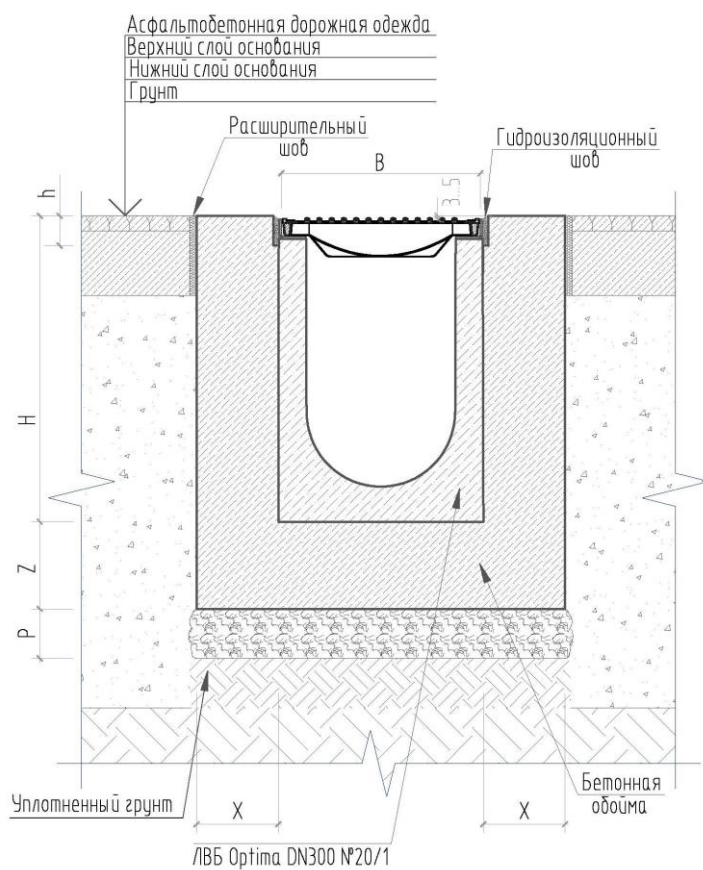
в – Устройство бетонной обоймы лотка с асфальтобетонным покрытием для классов нагрузки С250.
